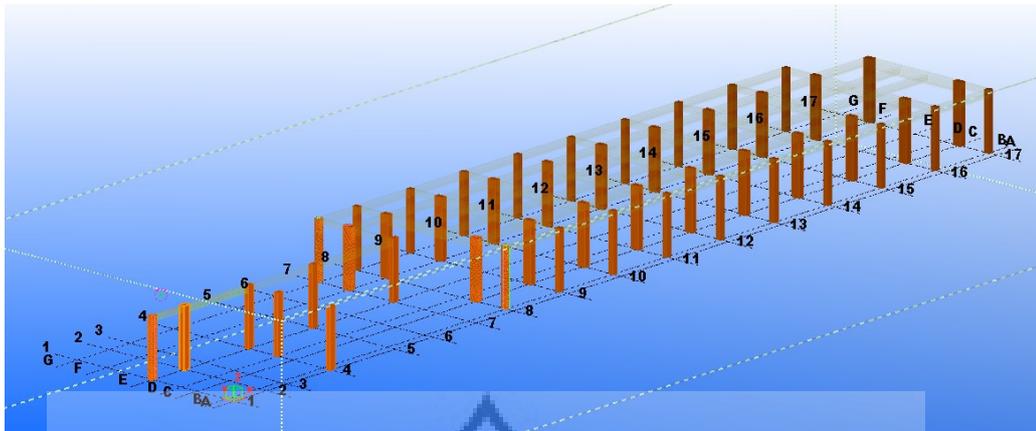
Tampilan *Create Concrete Column* pada *Concrete Toolbar
